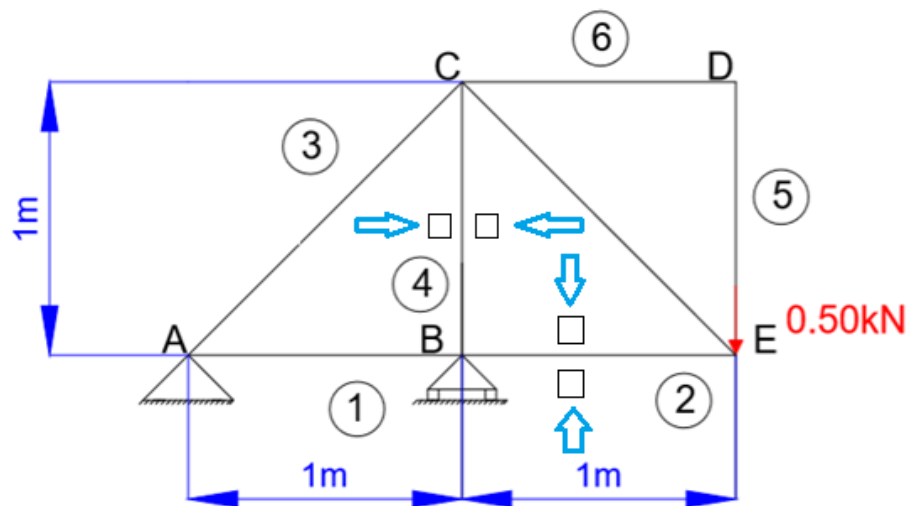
Ubicación de las galgas instaladas en la estructura.
